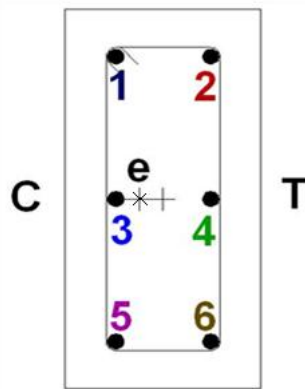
Posicionamento dos extensômetros na armadura longitudinal
